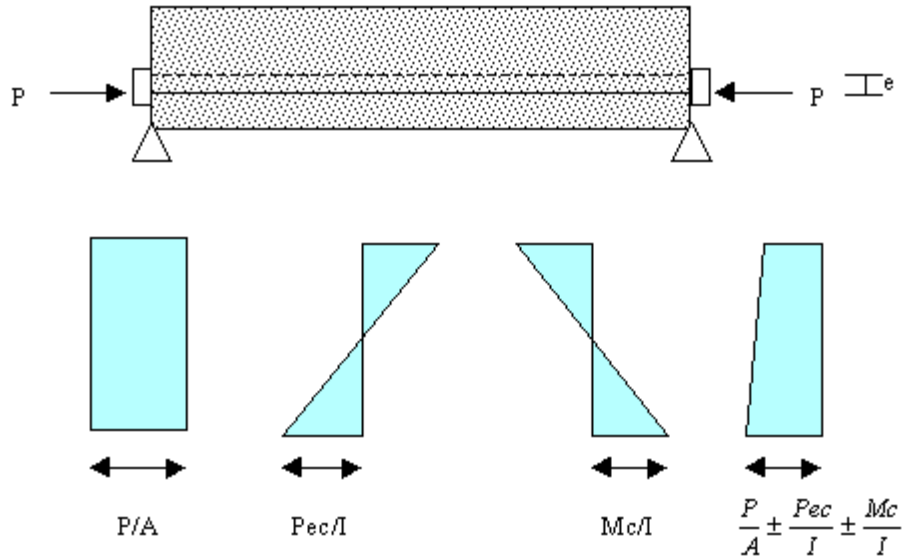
Distribución de esfuerzo a través de una sección de concreto presforzado excéntricamente.
